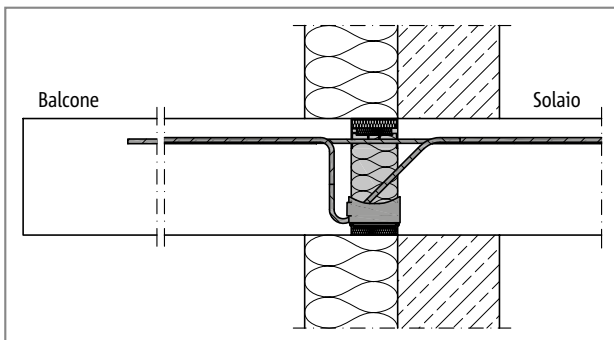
Schöck Isokorb® T tipo KL, raccordo con sistema di isolamento a cappotto
